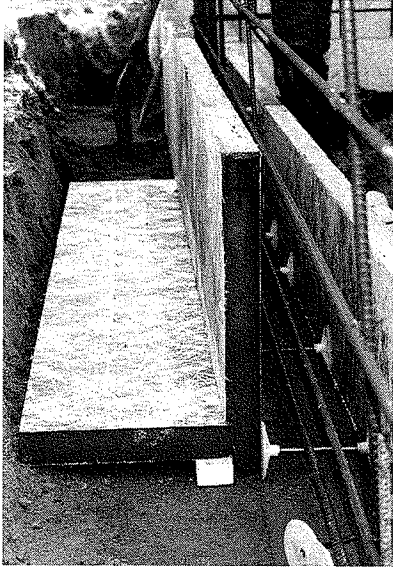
基礎断熱工法（外断熱）寒冷地スカート工法
